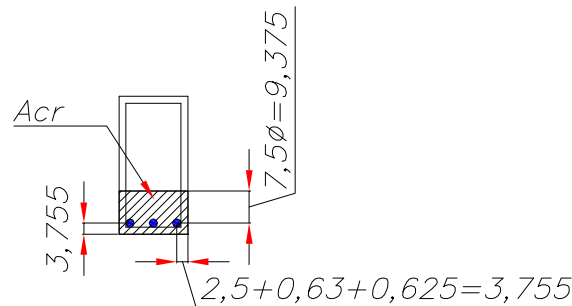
Detalhamento da seção transversal Viga V5 - Momento Positivo
